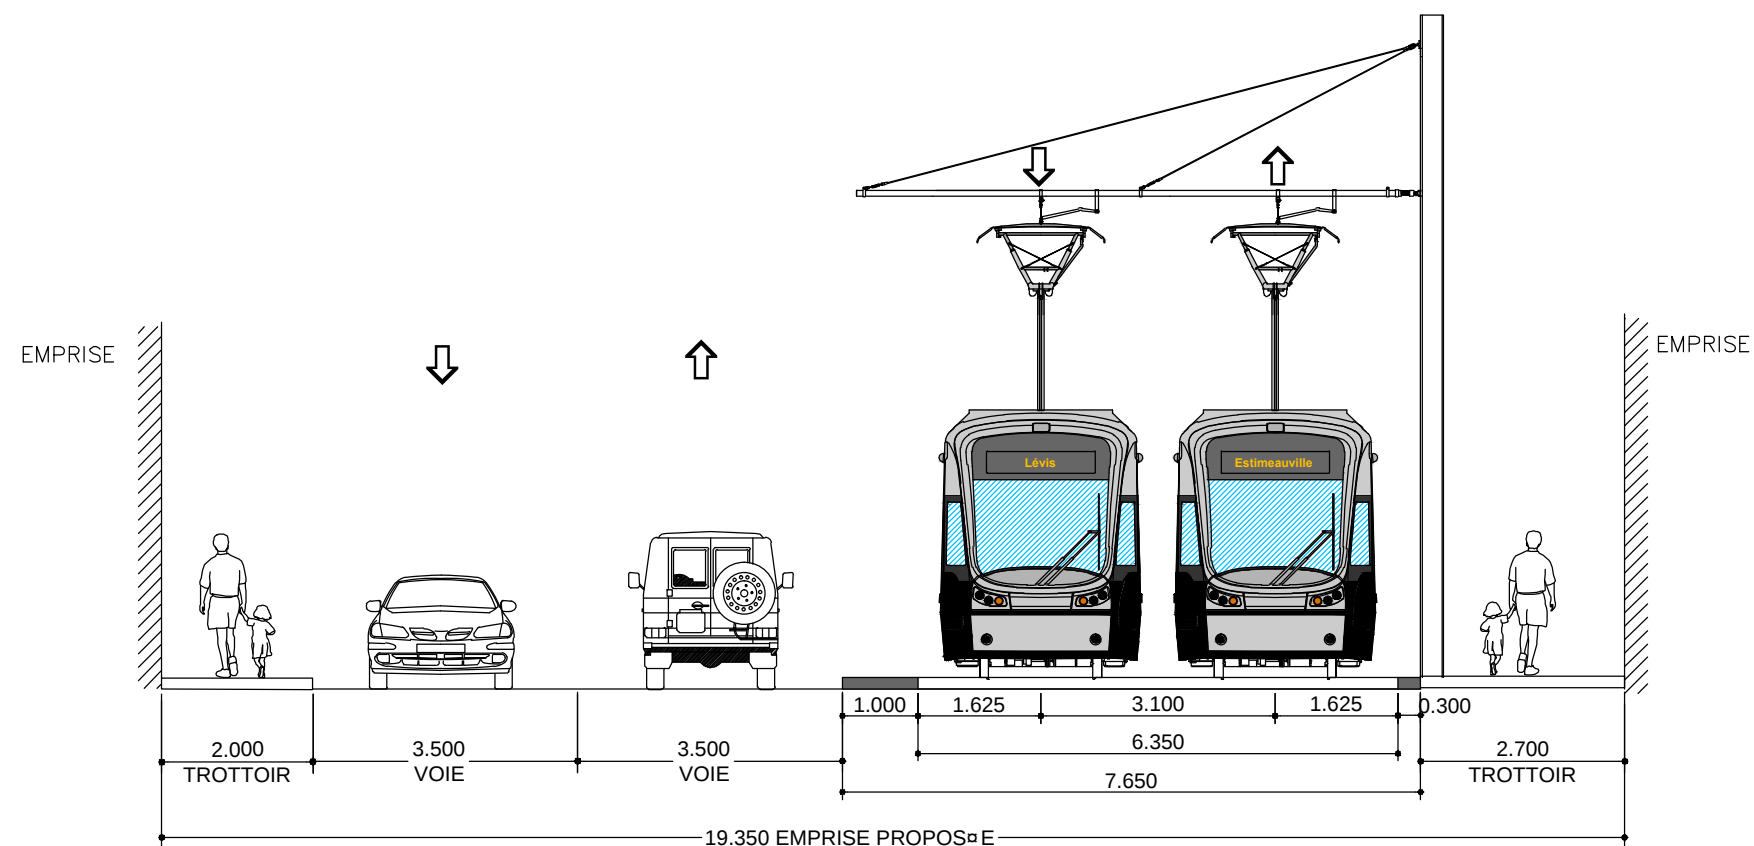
Coupe type 06 de 15 - SRB - Site propre standard - Station avec quais latéraux
